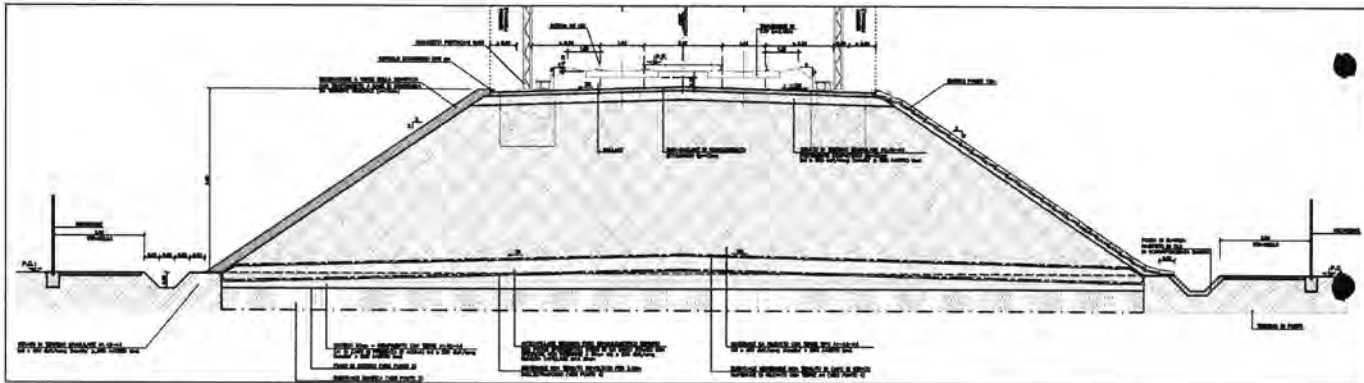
Sezione tipo rilevato doppio binario nuova sede.
